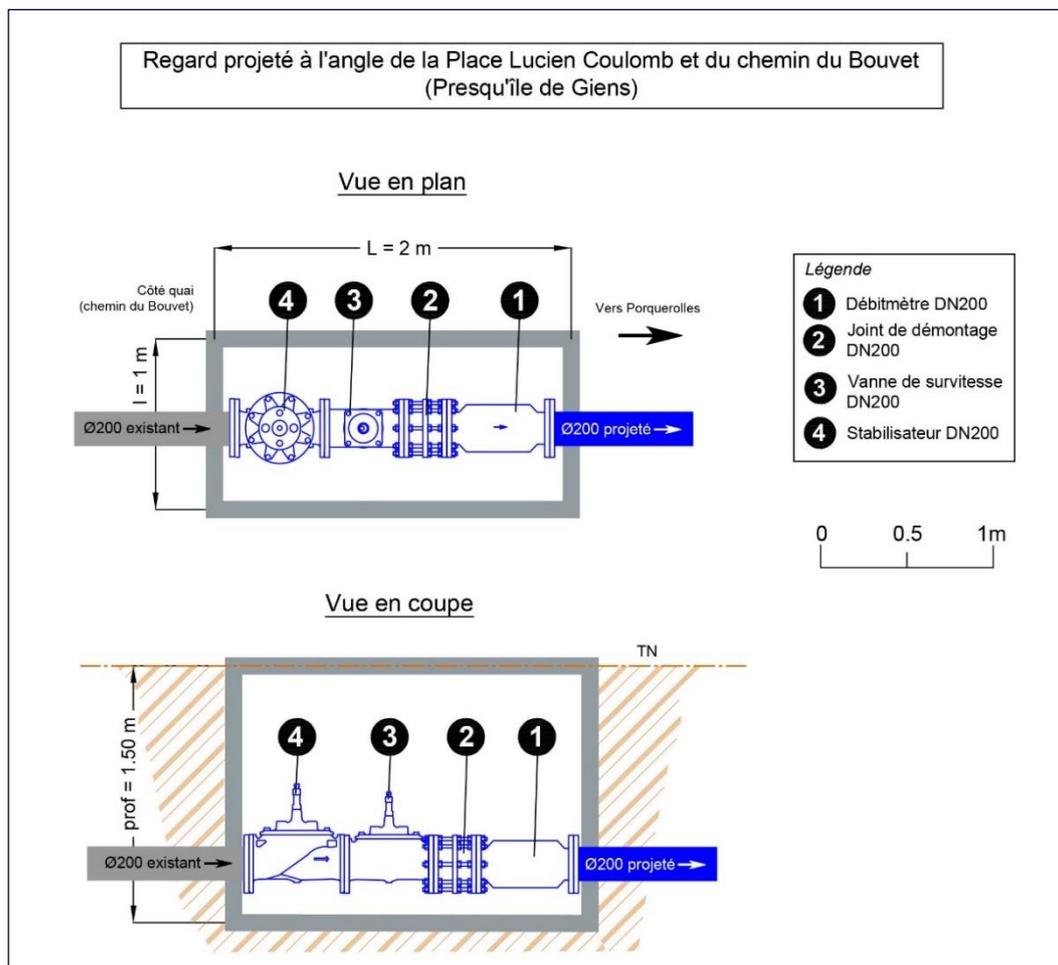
Vues en plan et en coupe du regard projeté : côté Giens
